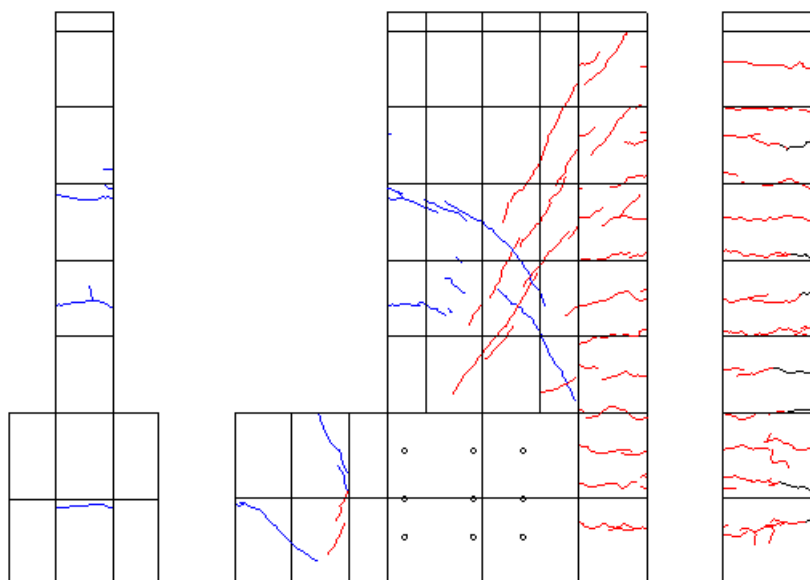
R=1/133 ひび割れ図
